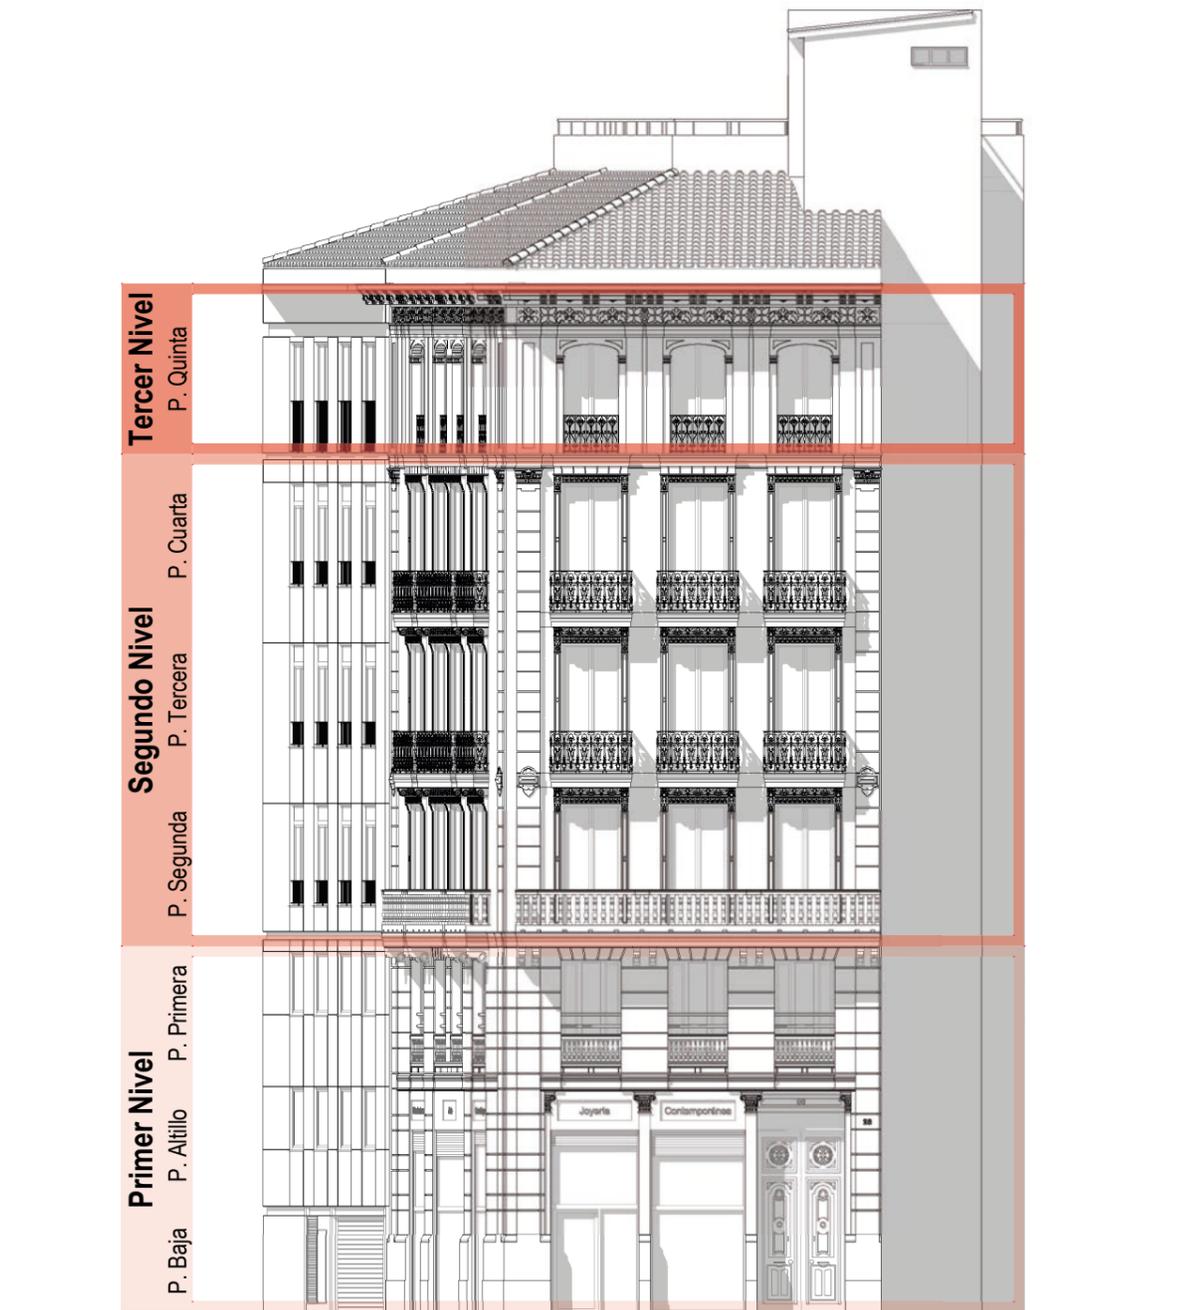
Alzado compositivo. División fachada original en niveles de ornamentación.
